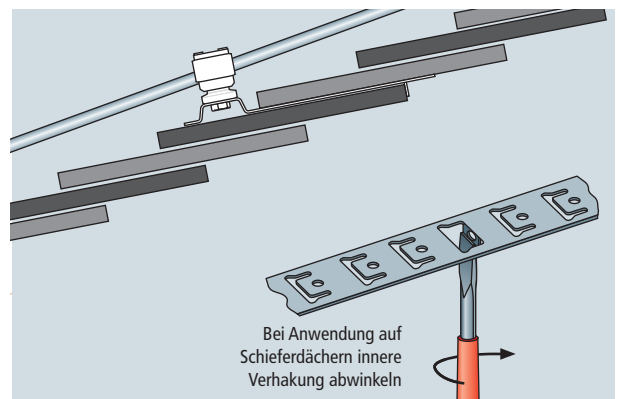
Dachleitungshalter UNIsnap mit geprägter Strebe – Anwendung auf Schieferdächern
